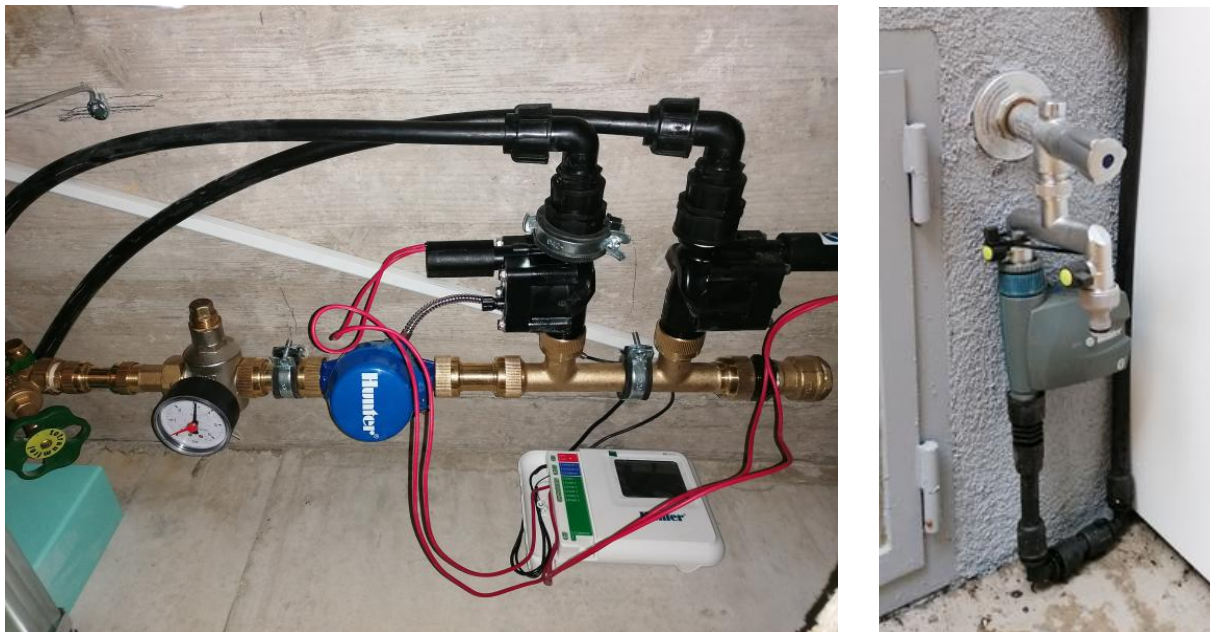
Steuerung mit Magnetventilen im Innenraum (links) und mit Batterie-Steuergerät außen (rechts)
